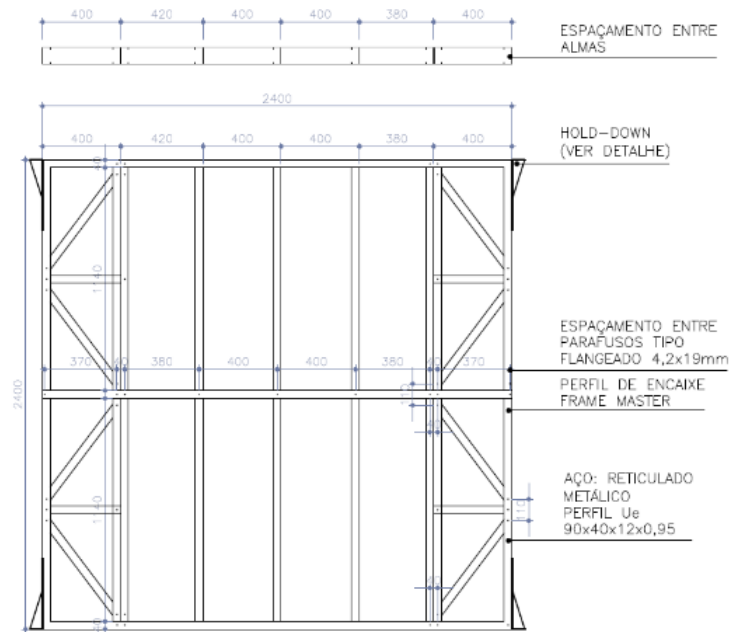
Modelo em light steel frame com treliças verticais. (DE FARIA, 2023)
